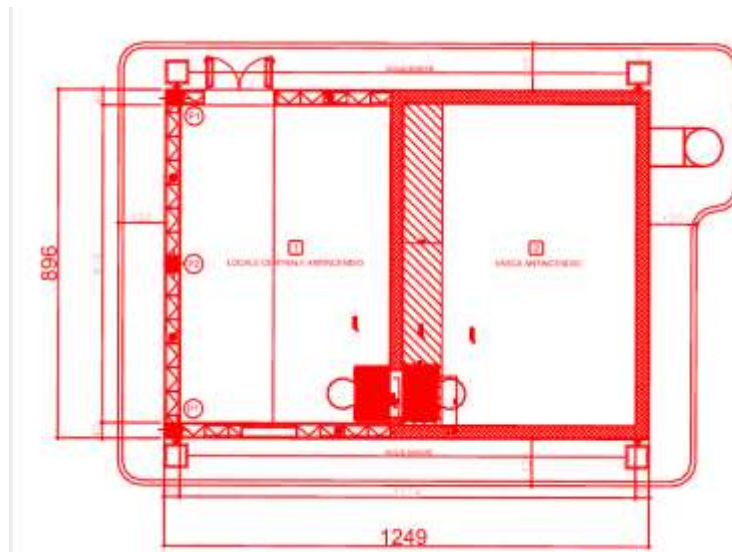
Pianta piano terra del fabbricato FA1G nel Progetto di variante.
